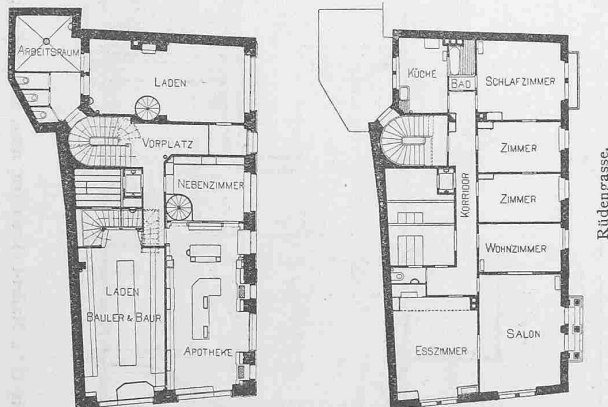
Die «Goldene Apotheke». Grundrisse vom Erdgeschoss und vom III. Stock. — Masstab 1:400.
